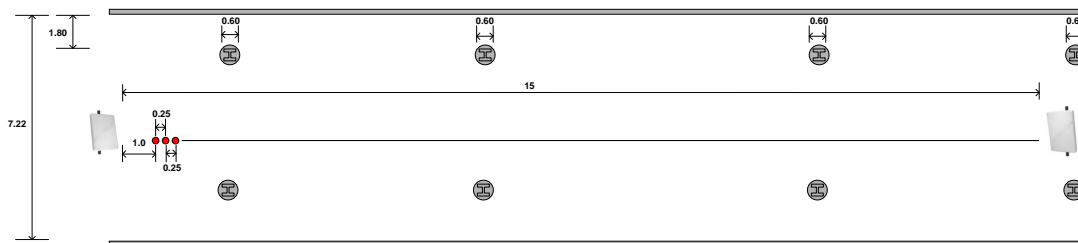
Plano del pasillo junto a los laboratorios C005 –C007, Planta baja, Edificio C
